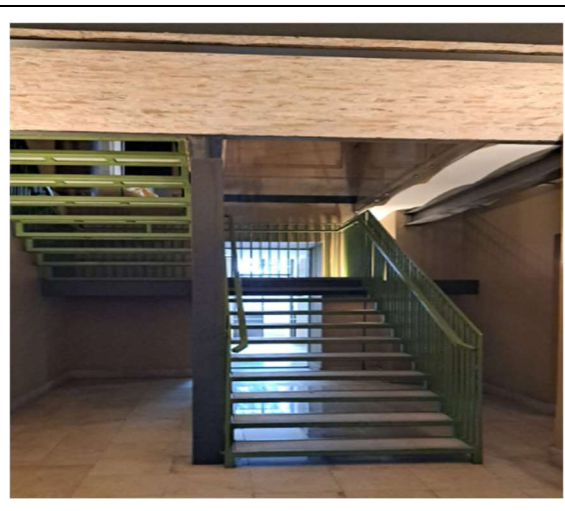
Implantação de iluminação para acesso ao pavimento inferior, escada.
